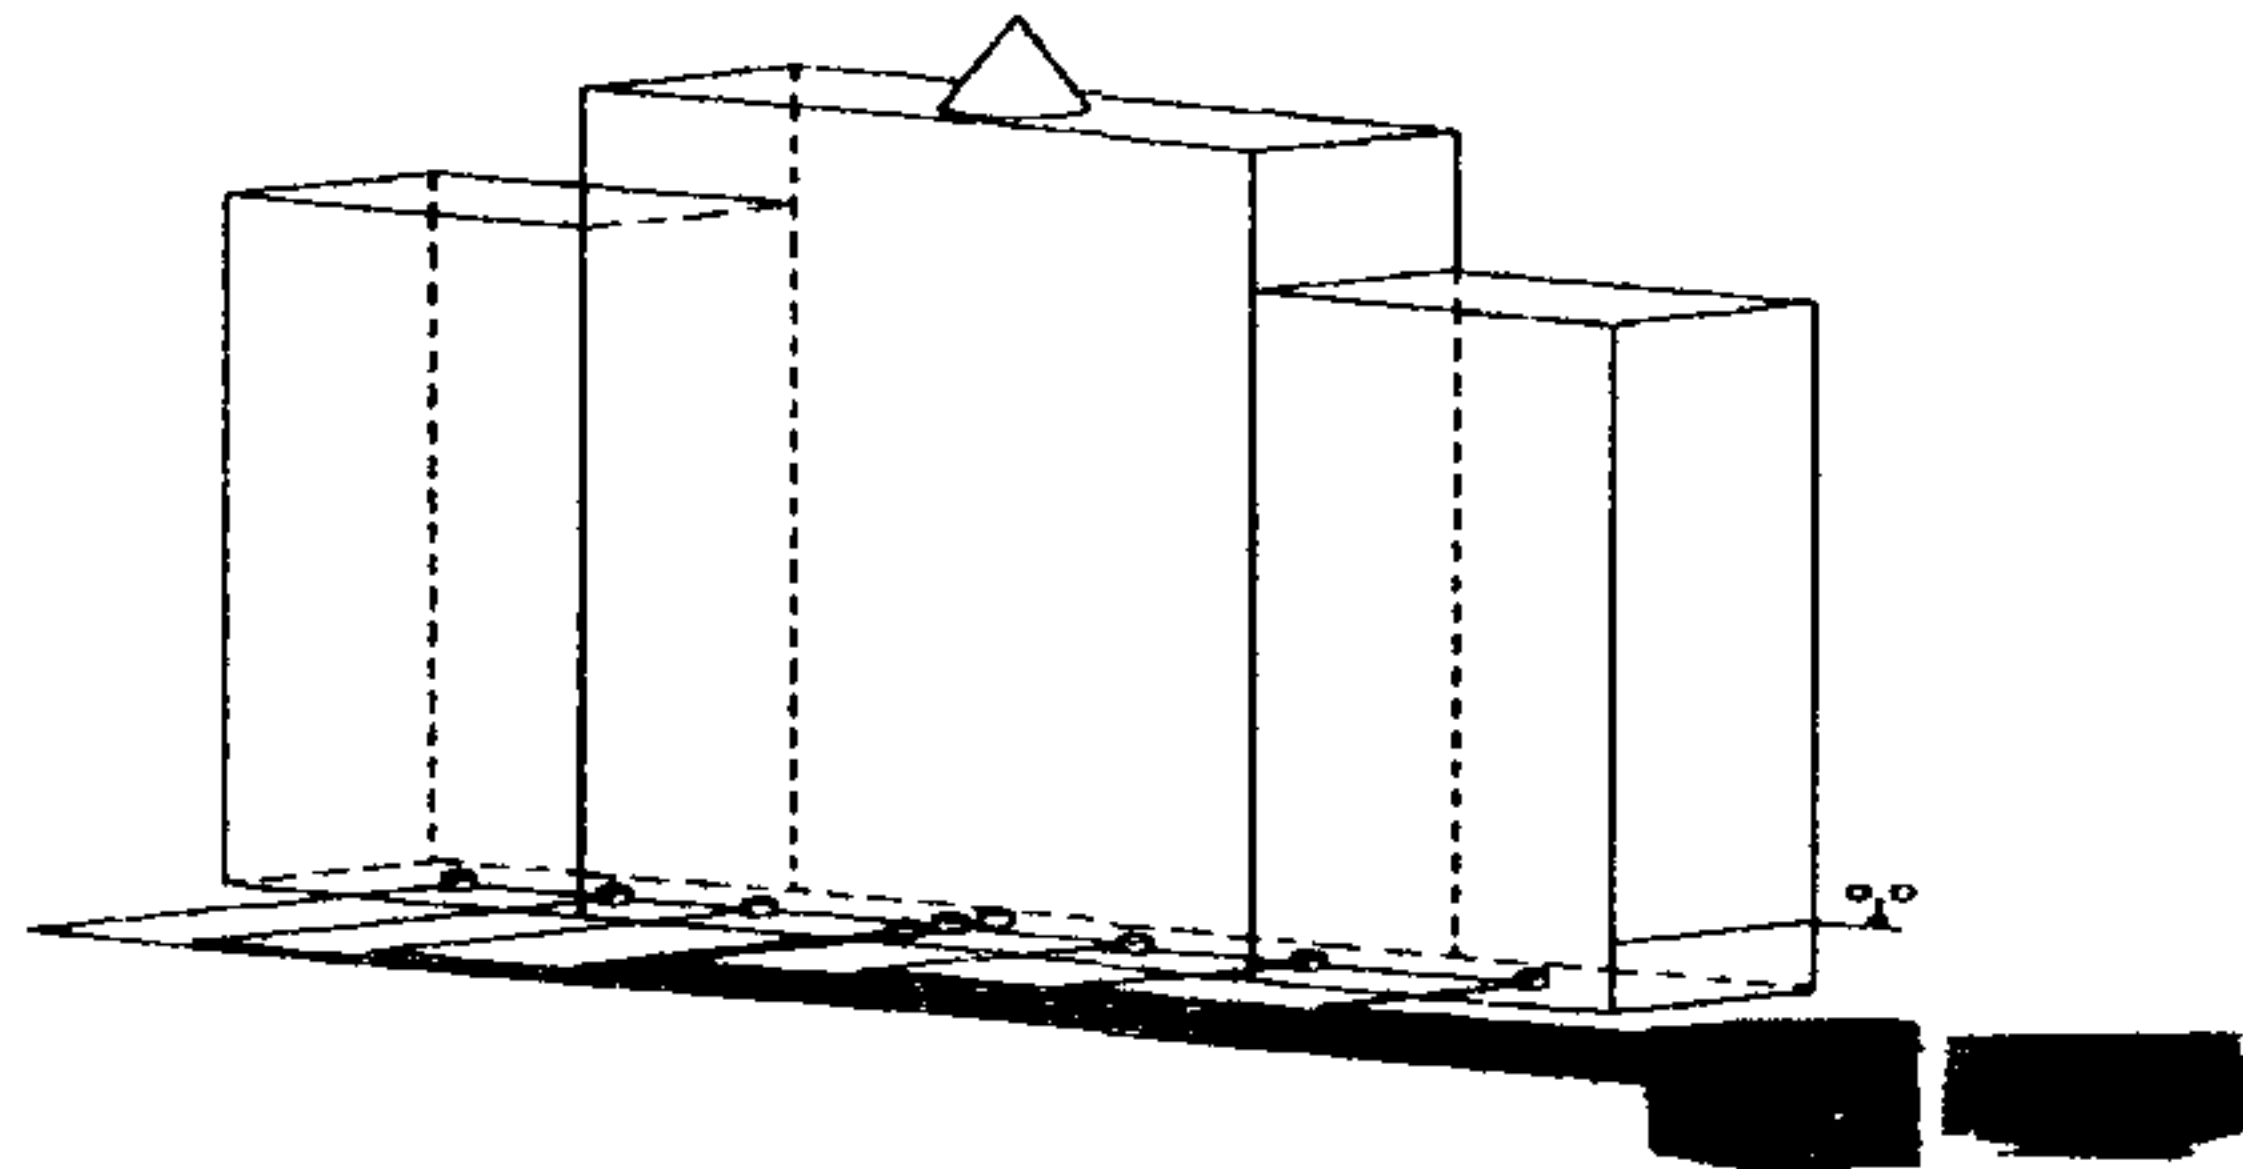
Схема размещения головок видеогидростатической системы на фундаменте высотного здания
